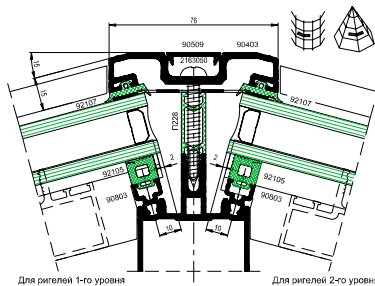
Сечение шарнирной стойки на изломе плоскостей покрытия фасада (наружный угол)
